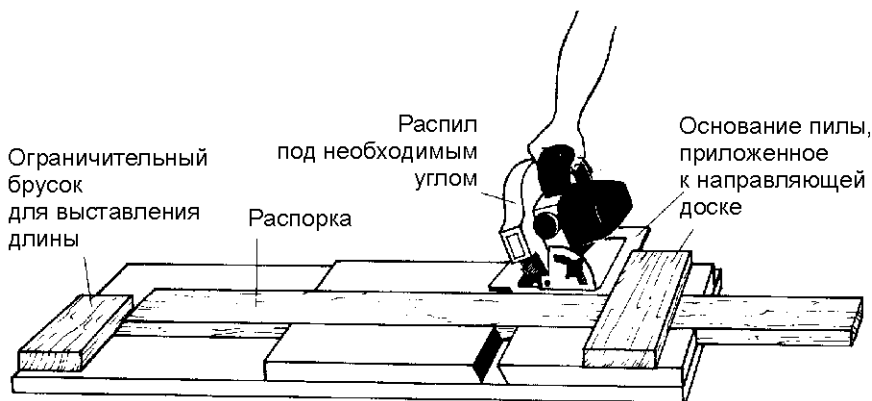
Можно изготовить шаблонное приспособление для нарезания распорок
